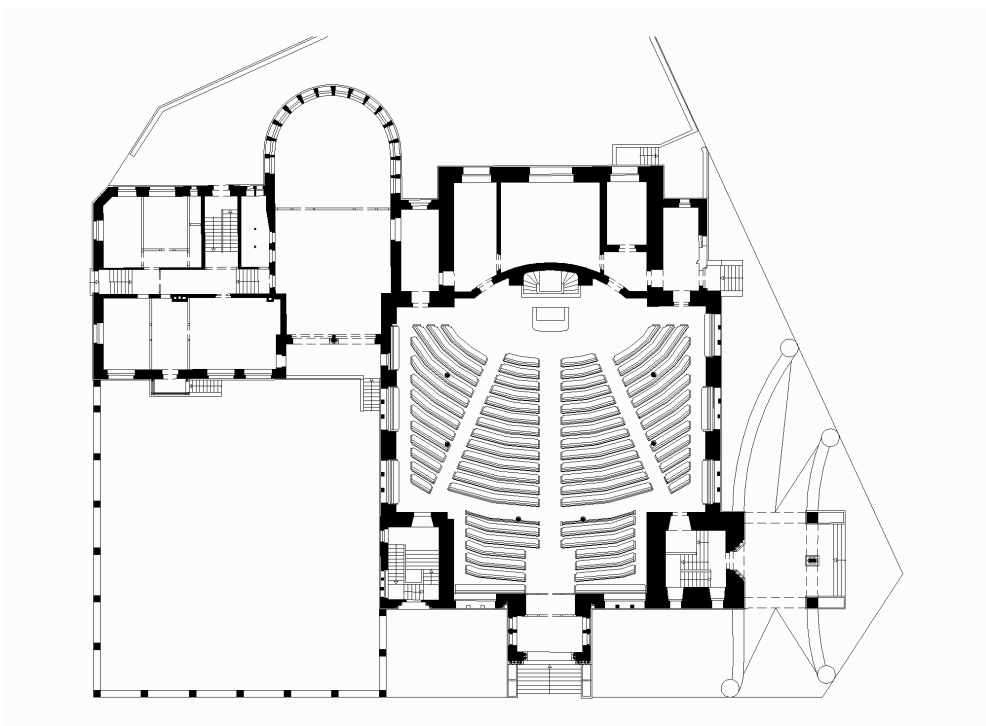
Karlsruhe, Lutherkirche, Grundriss
